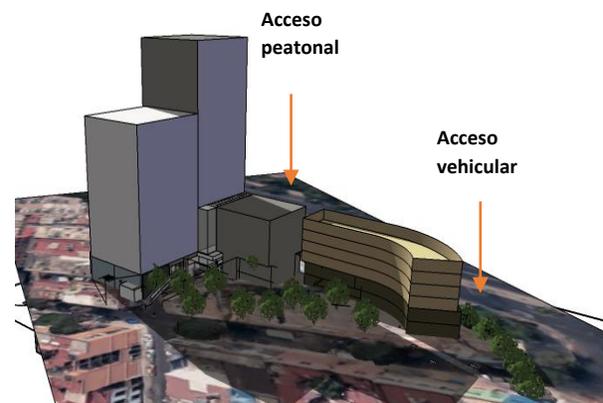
primera propuesta de volumetría para edificios. Vista desde calle galeana
